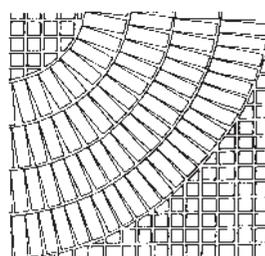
Adaptación de áreas pavimentadas a formas redondas con ayuda de pavimento de mosaico.
